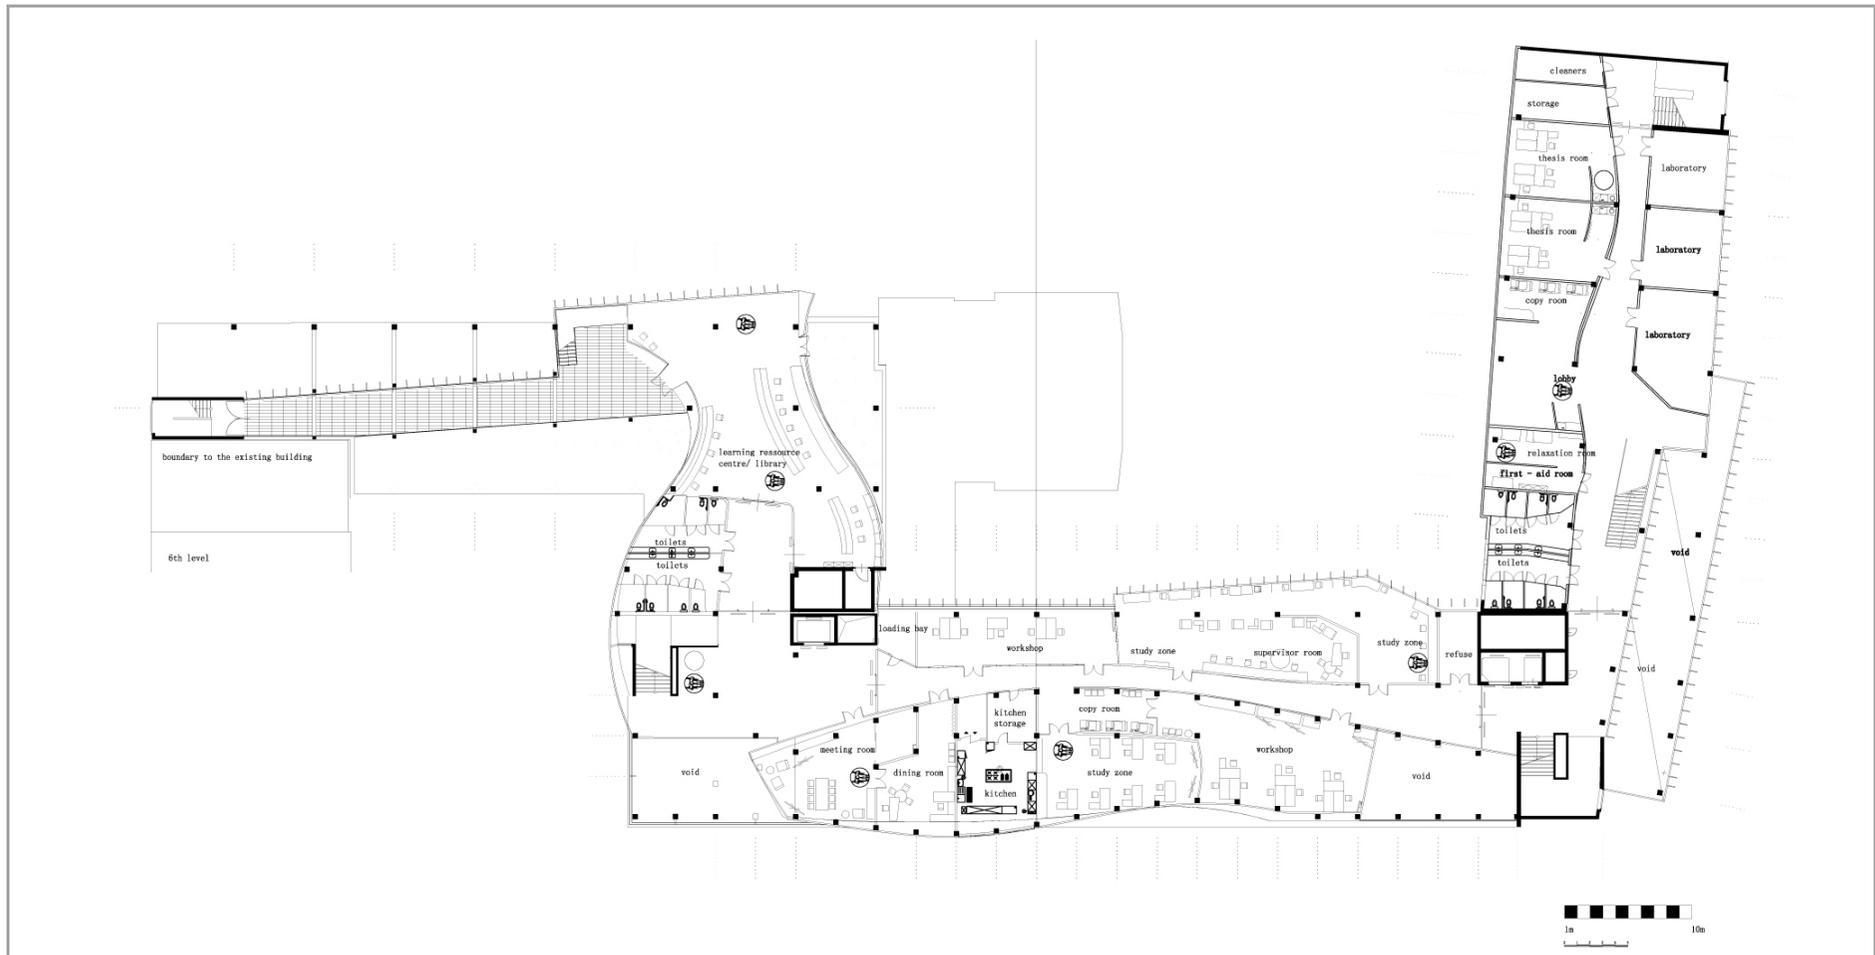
Dachaufbau Syarova – Ebene 1 (Key Station der TU Wien, 2008)
